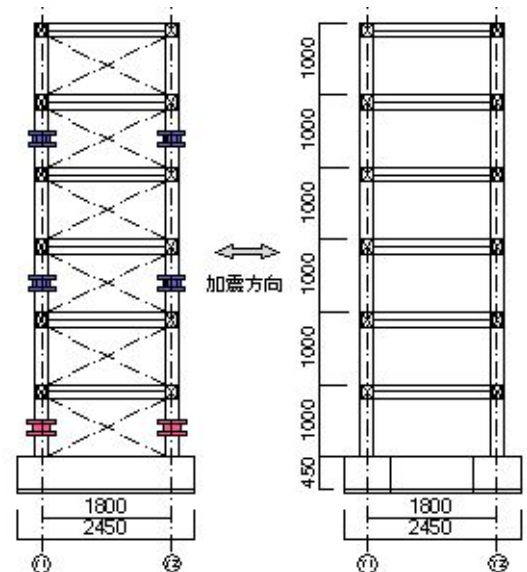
純フレーム構面立面図及び, 連層耐震壁構面立面図
